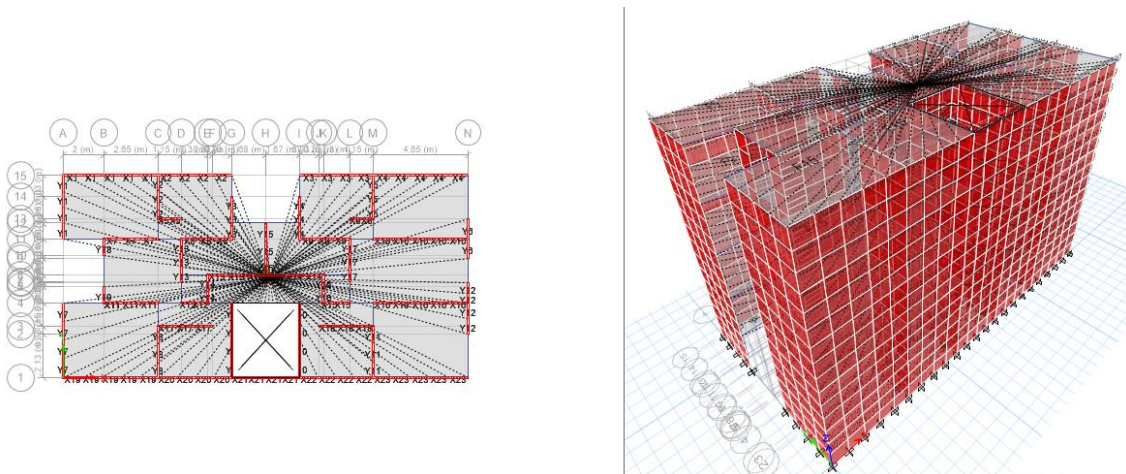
Vista en planta y 3D en el software ETABS de la edificación de 5 pisos de muros de ductilidad limitada.
